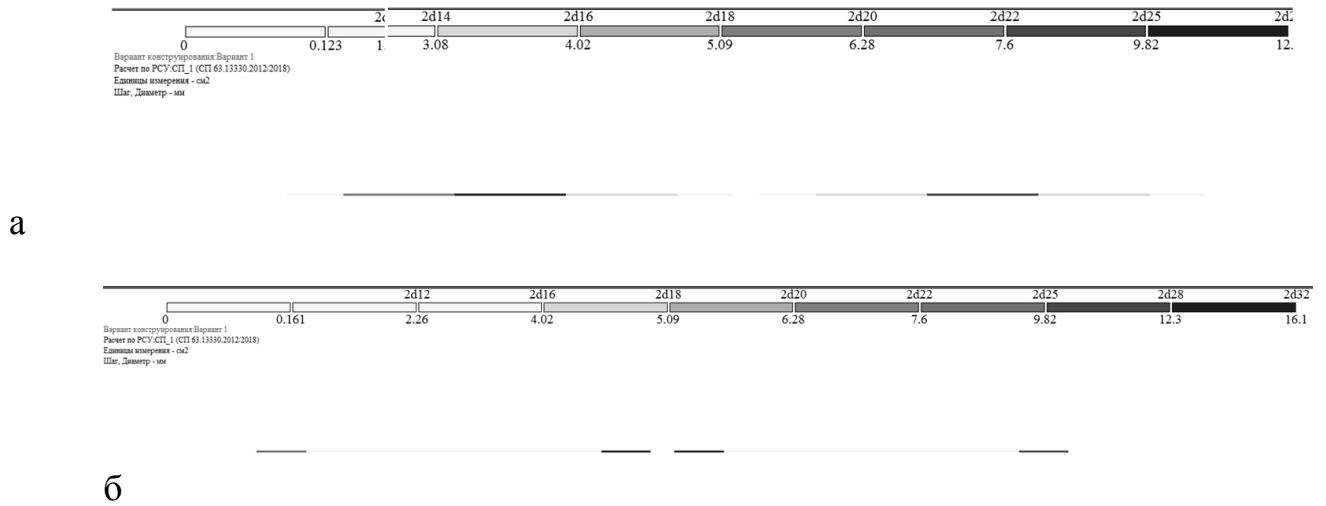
Мозаика подобранного армирования в двух крайних ригелях:
